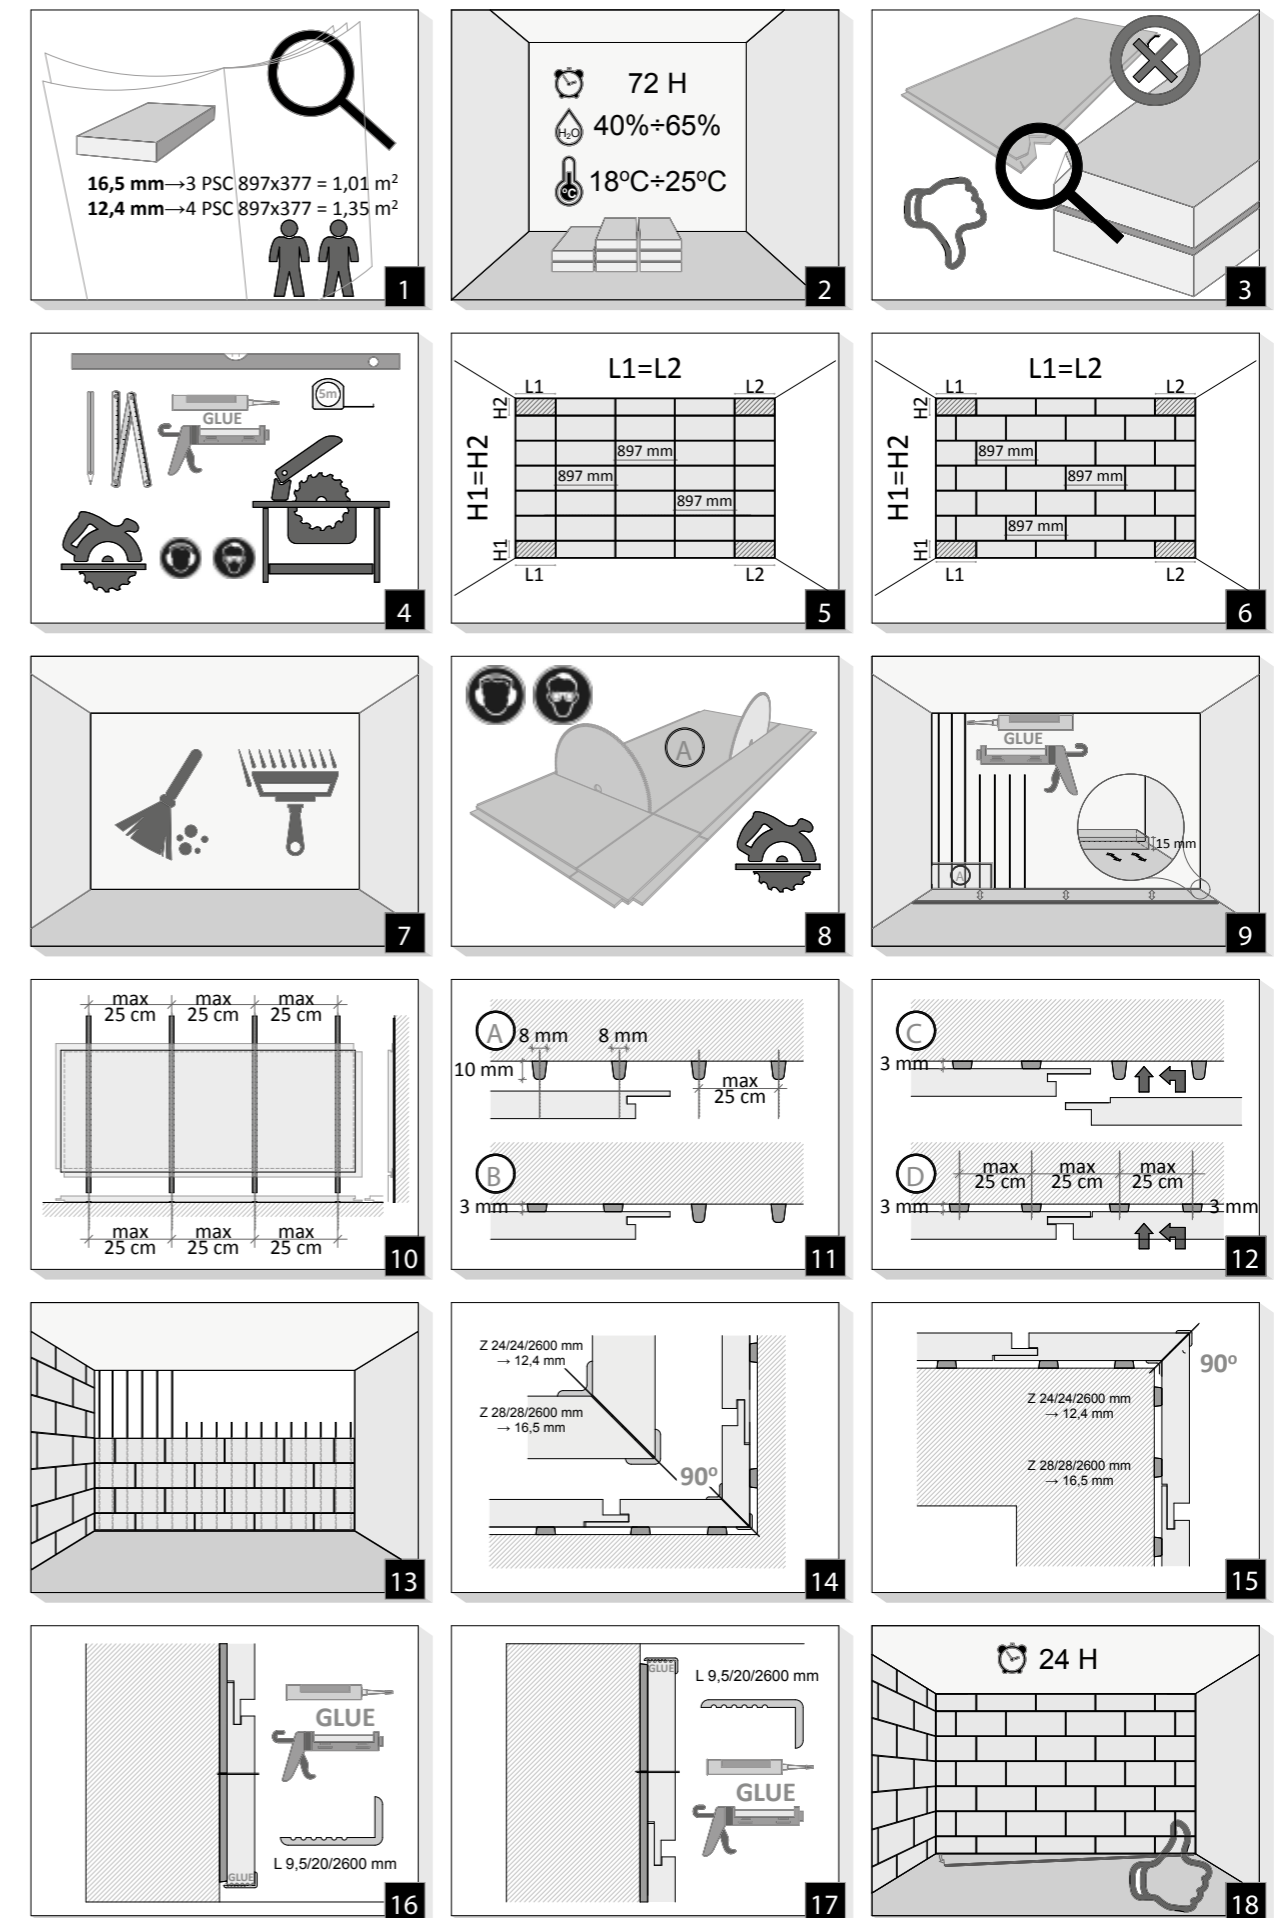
Schemat montażu WALLDESIGN za pomocą kleju montażowego.
